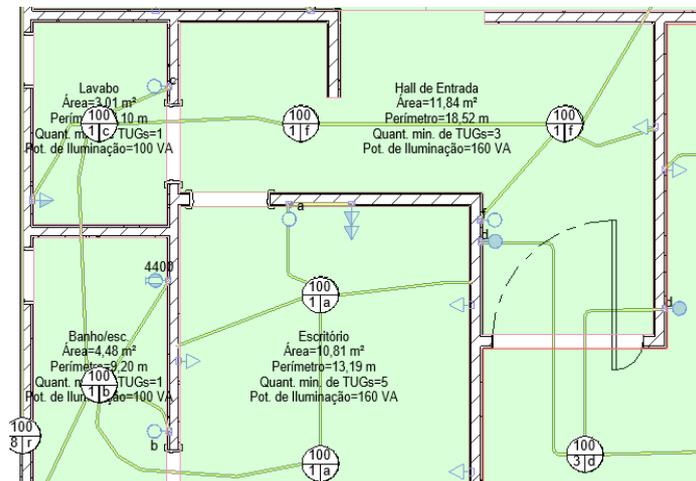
Trecho do Pavimento Térreo Exemplificando Alguns Elementos do Projeto Elétrico
